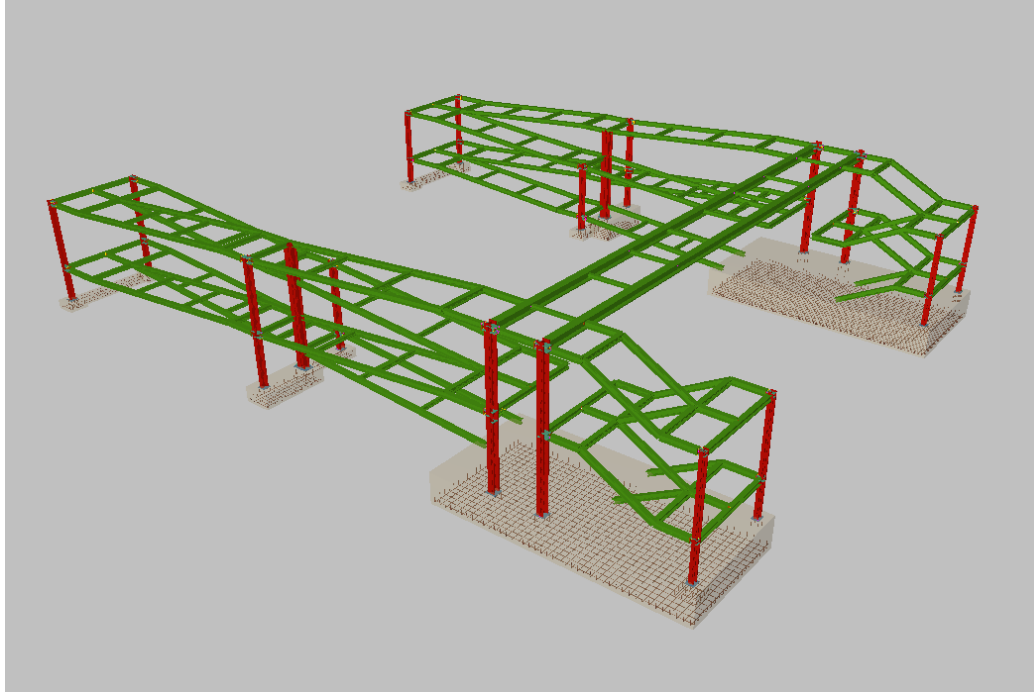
Estructura 3-D de la cimentación.
